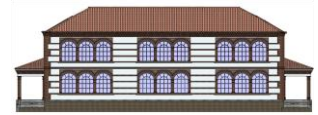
Alzado posterior. “Aurelio Gómez Millán: Arquitectos”.
